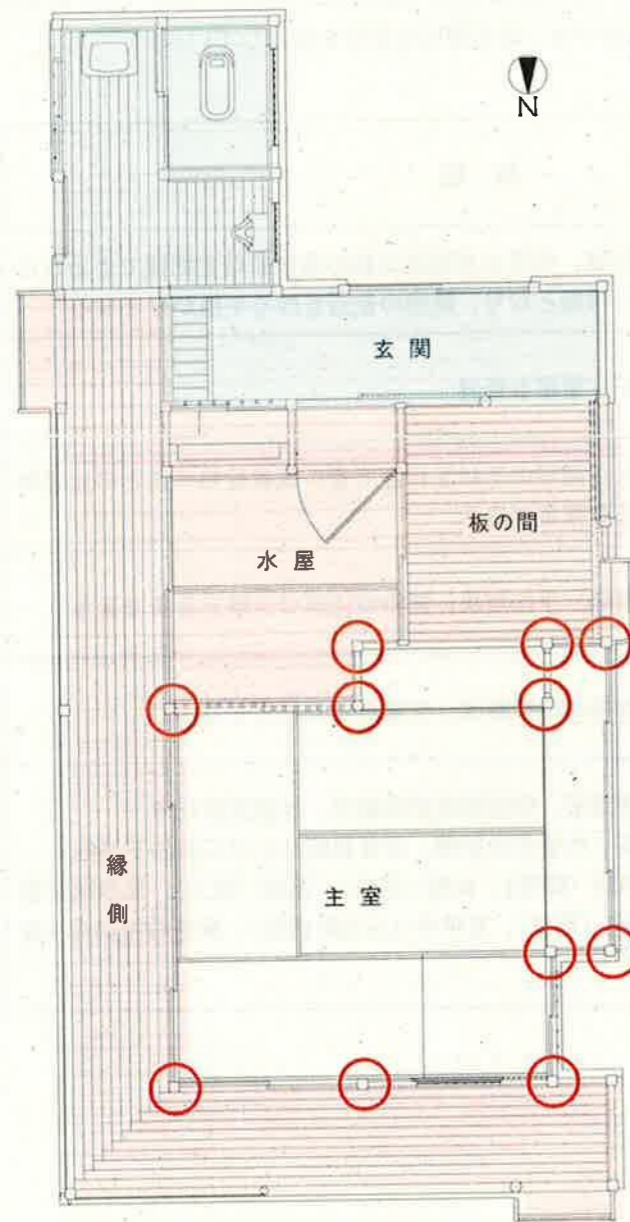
昭和 14 年移築時の平面図 (名古屋市文化財の指定時の平面)
